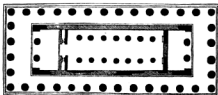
Grundriss des Poseidontempels zu Pästum.
